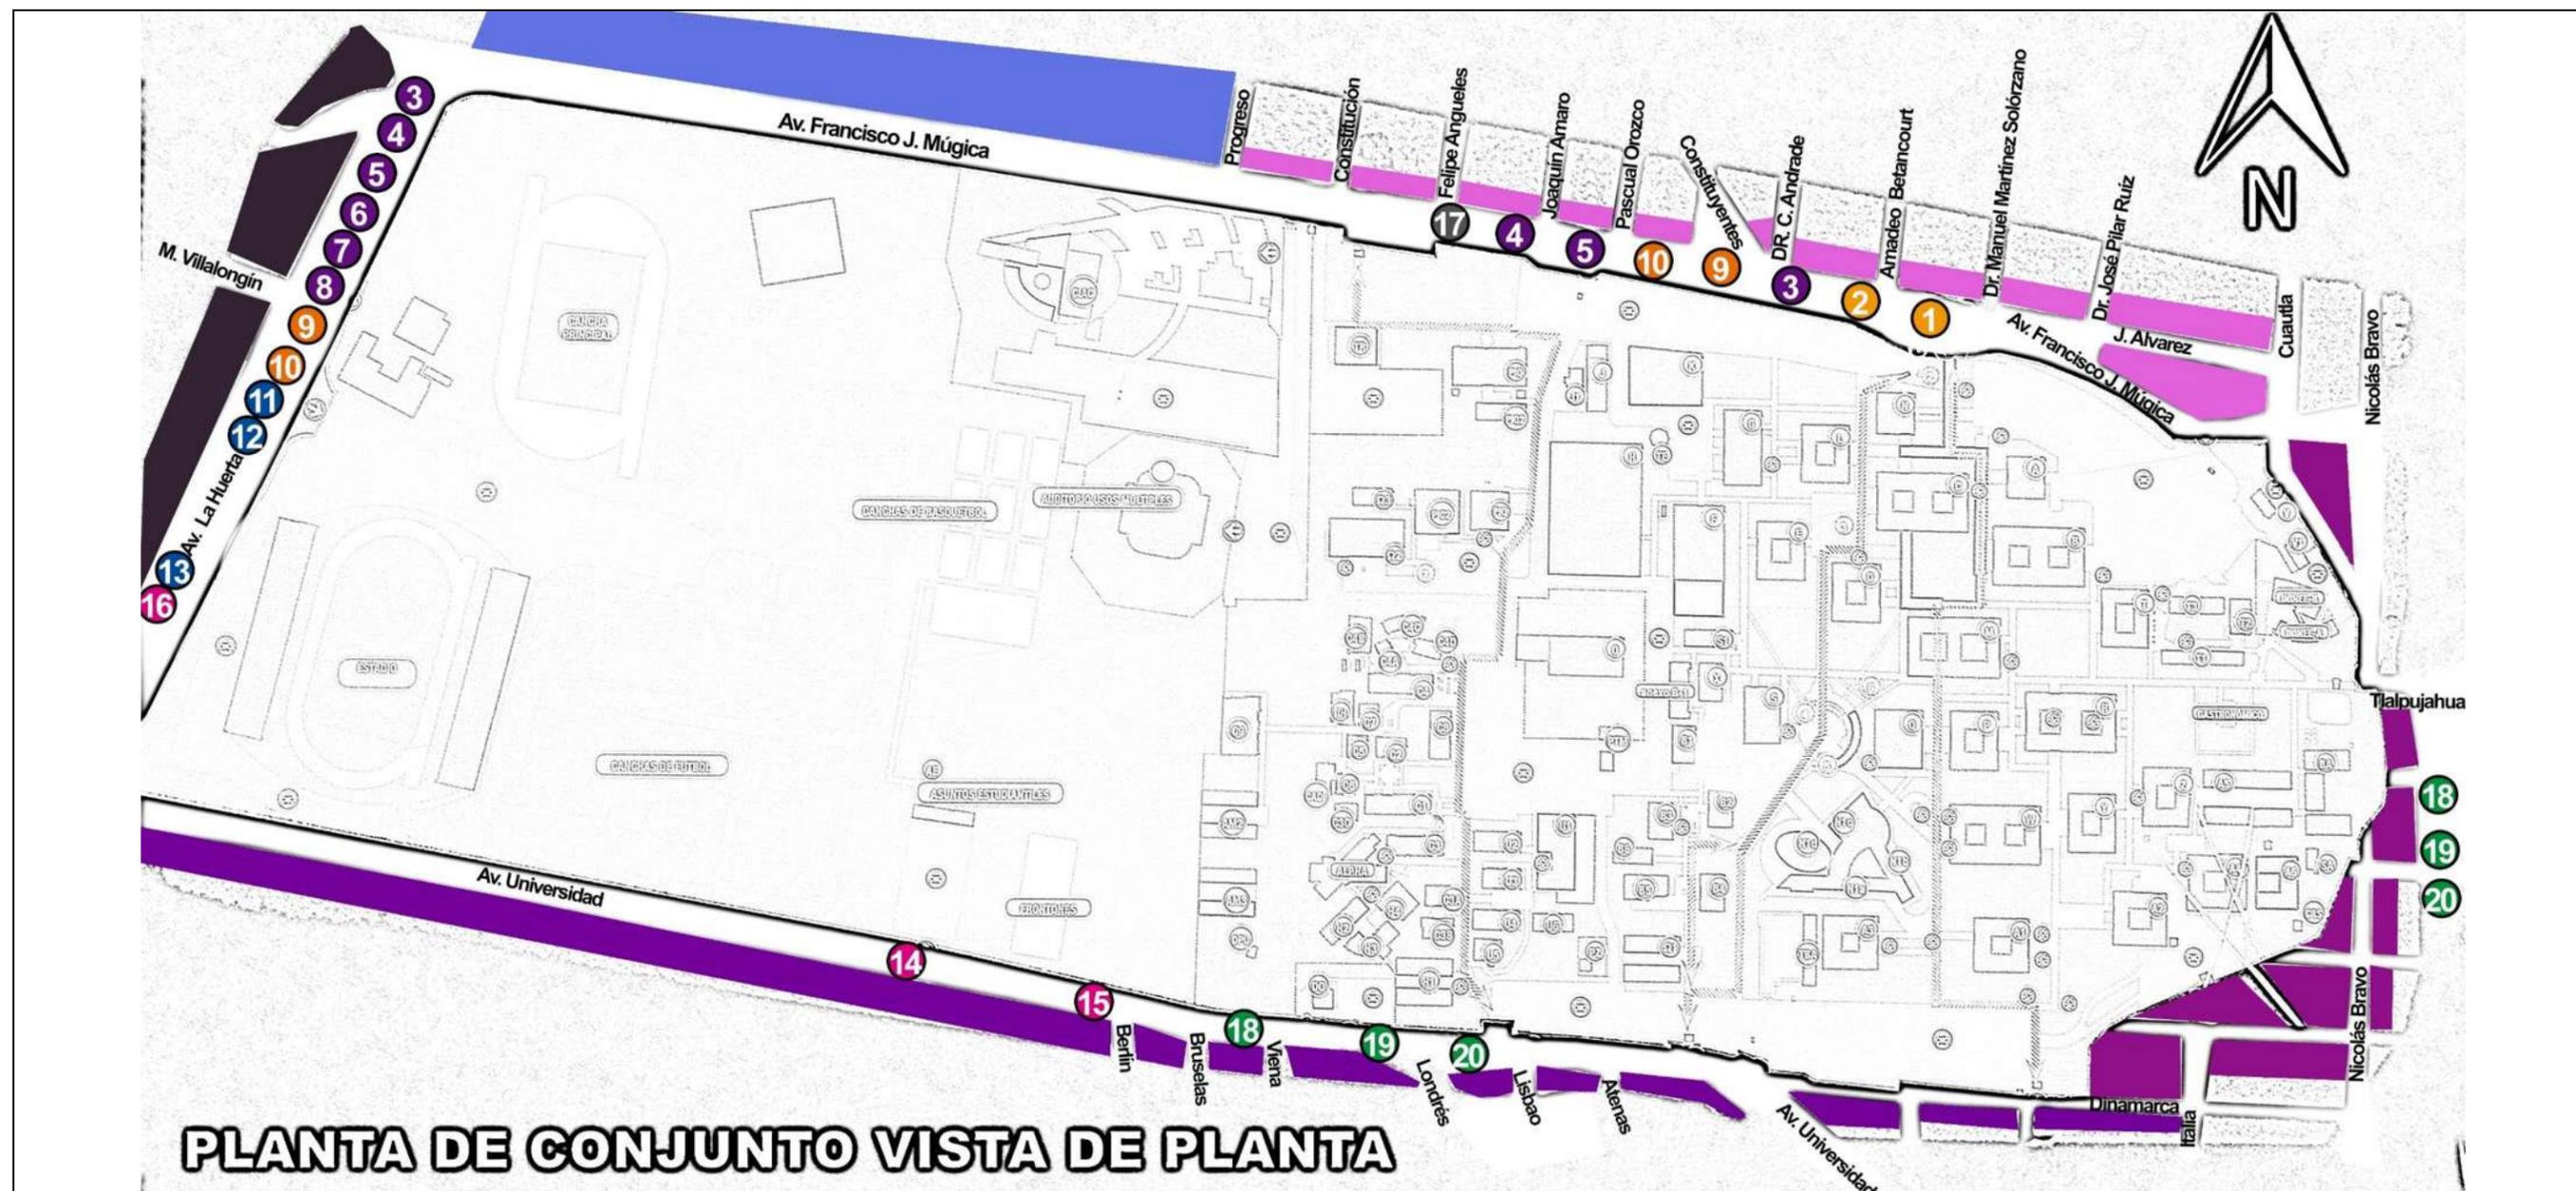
"Planta de conjunto vista en planta que muestra la localización de los estacionamientos y los ciclo puertos"
